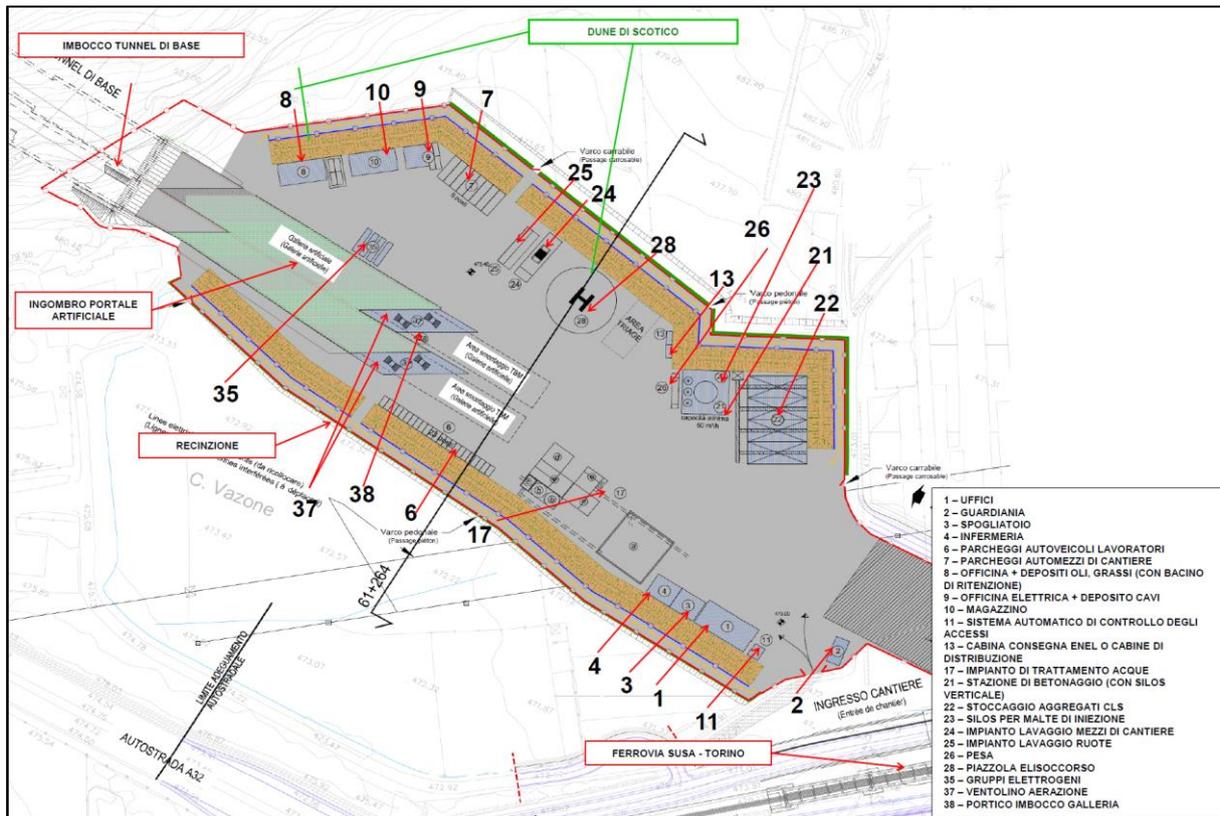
Layout cantiere Imbocco Est Tunnel di Base
